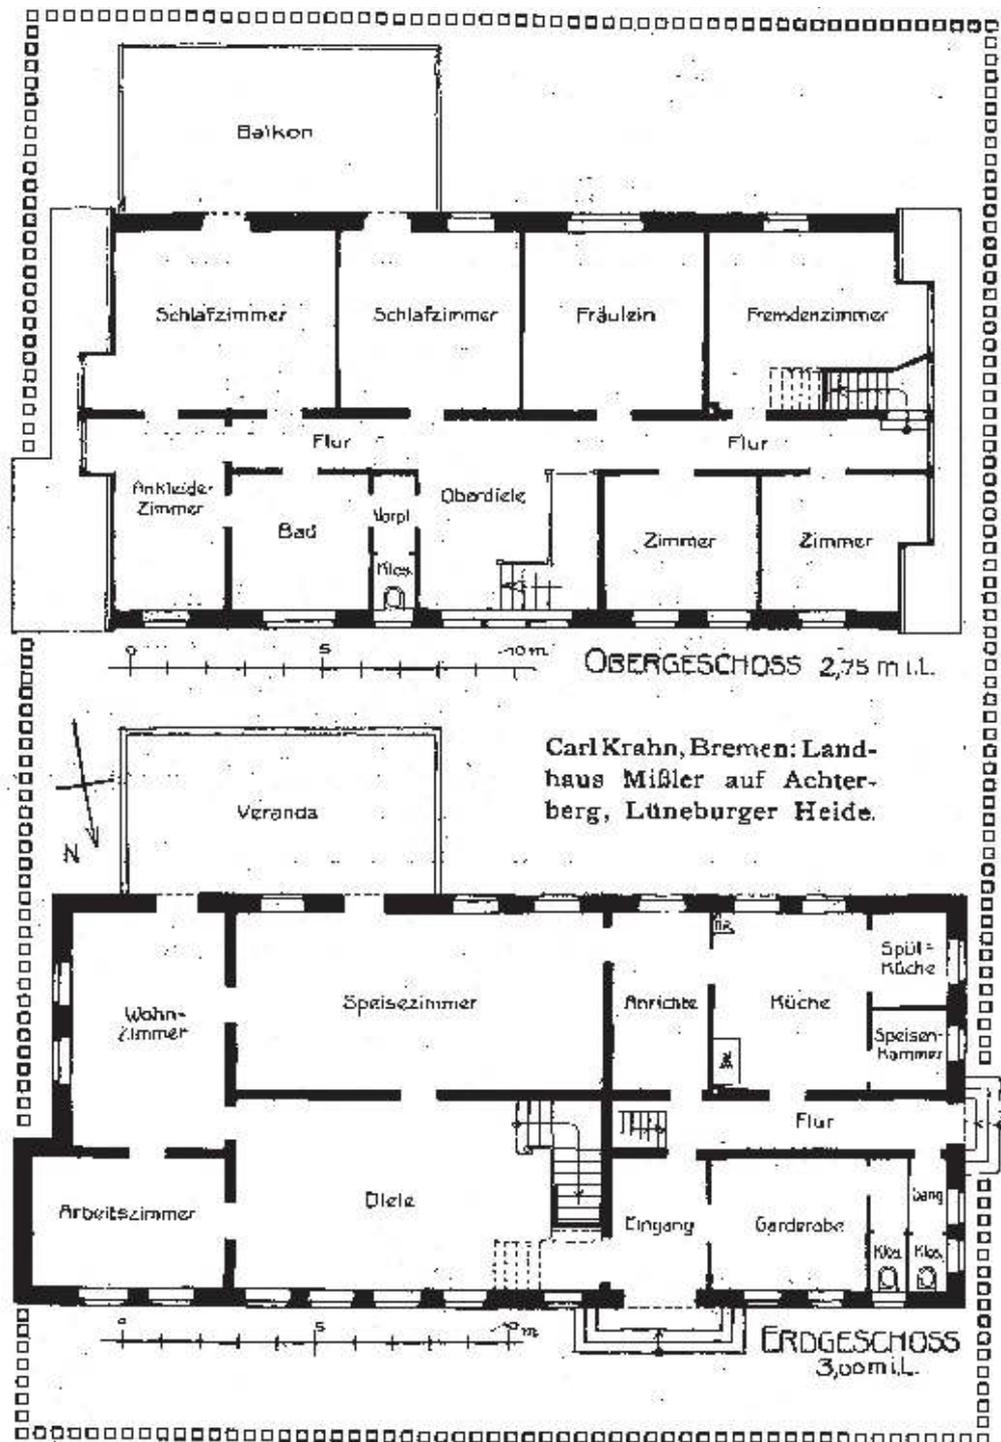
Carl Krahn: Landhaus Mißler bei Achternberg, Grundrisse Ober- und Erdgeschoss, Lüneburger Heide, im Bau 1910
